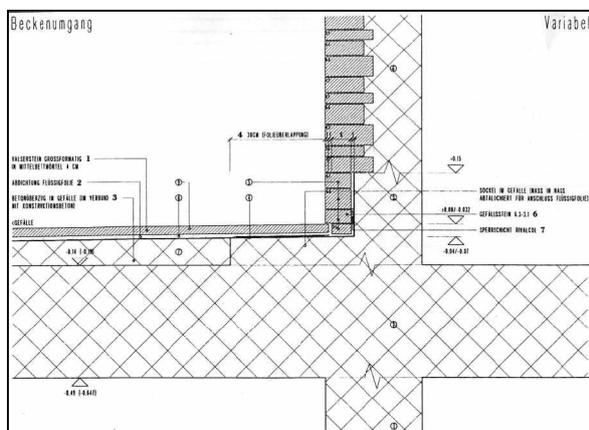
Detalle constructivo que ilustra la utilización de la piedra y muro de concreto como unidad constructiva
